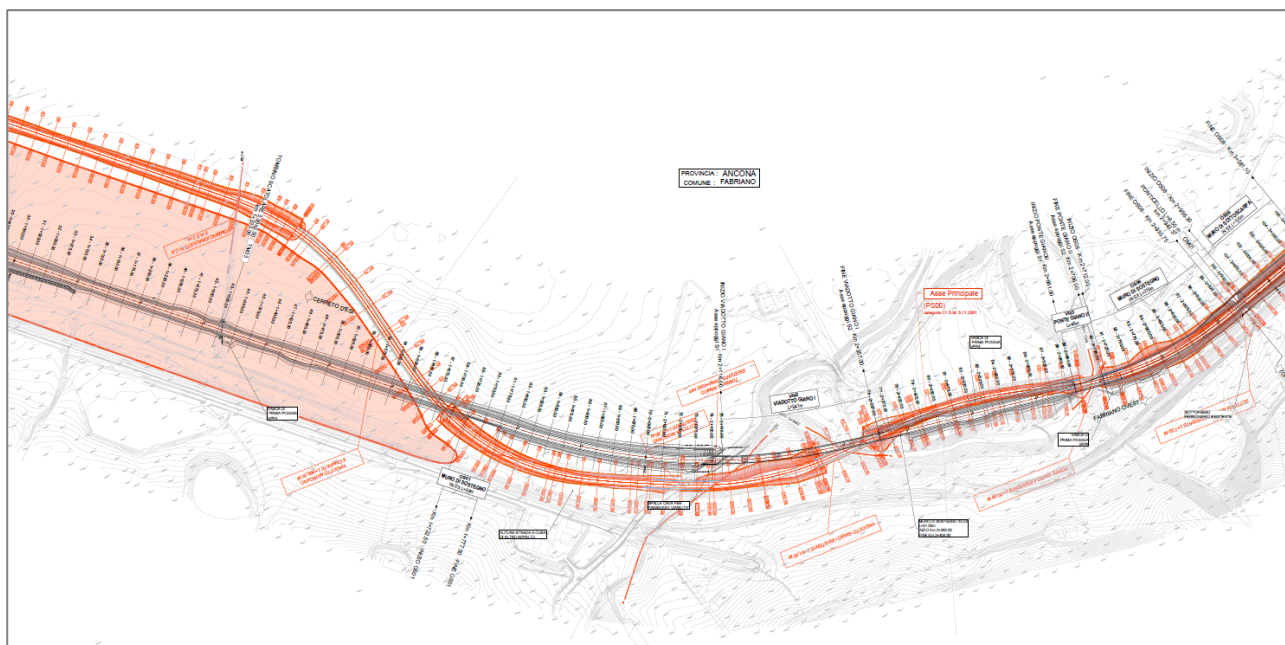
Planimetria di sovrapposizione del progetto definitivo al progetto preliminare - Tav. 2/3 Legenda: Progetto definitivo 2023 in tratto nero; Progetto preliminare del 2012 in tratto di colore arancio; area logistica stralciata nel 2023 in retinato di colore arancio (Fonte: Allegato 4 alla Lista di Controllo)
